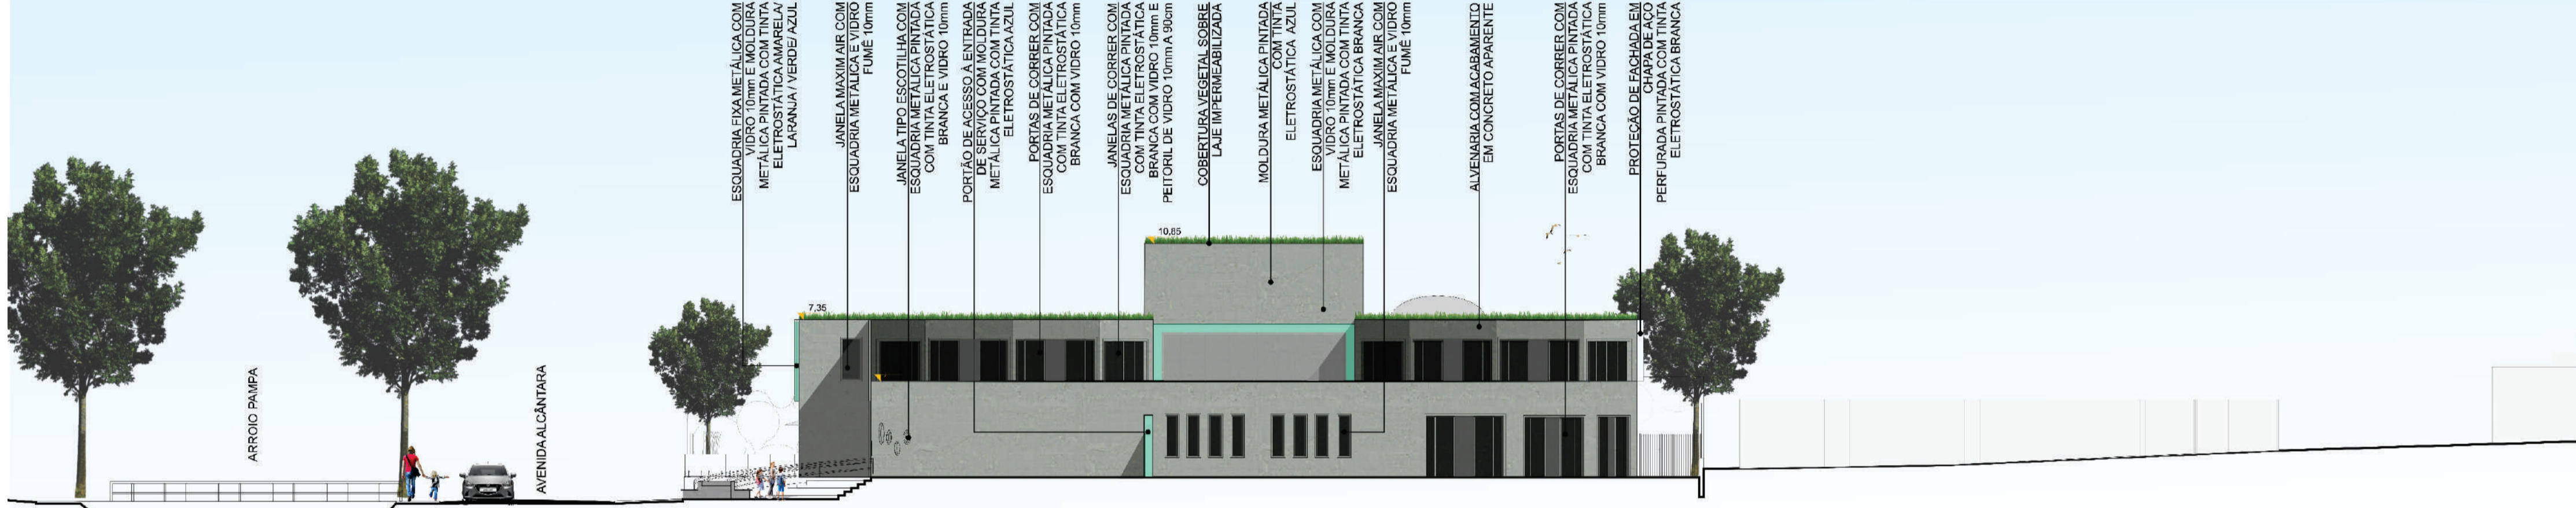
IMAGEM DA FACHADA SUL E DO CAMPO DE FUTEBOL
